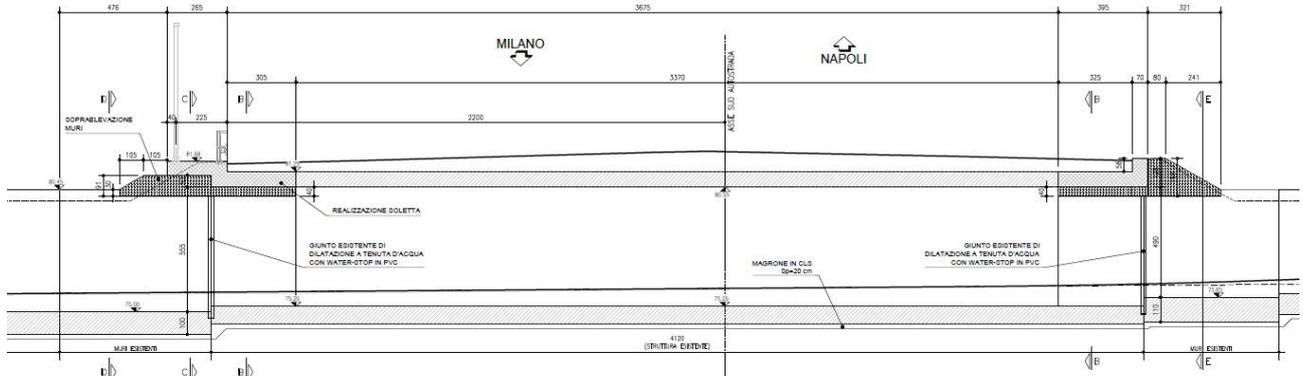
Sottopasso Via Piave - Sezione longitudinale dell'intervento
